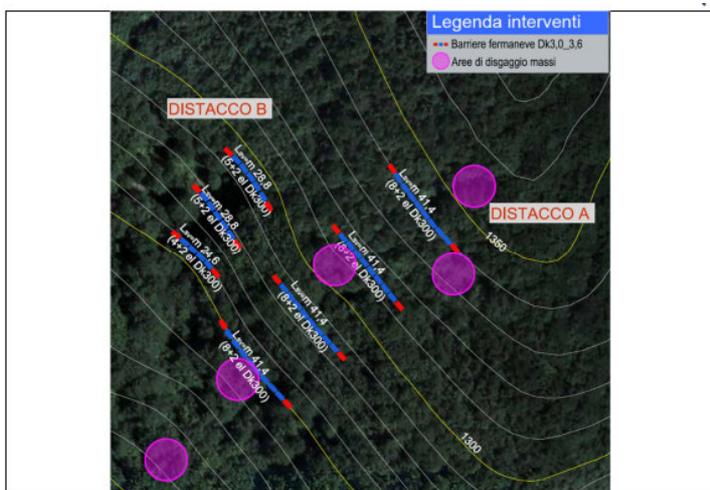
Planimetria barriere fermeneve in progetto (Elaborato B12)
